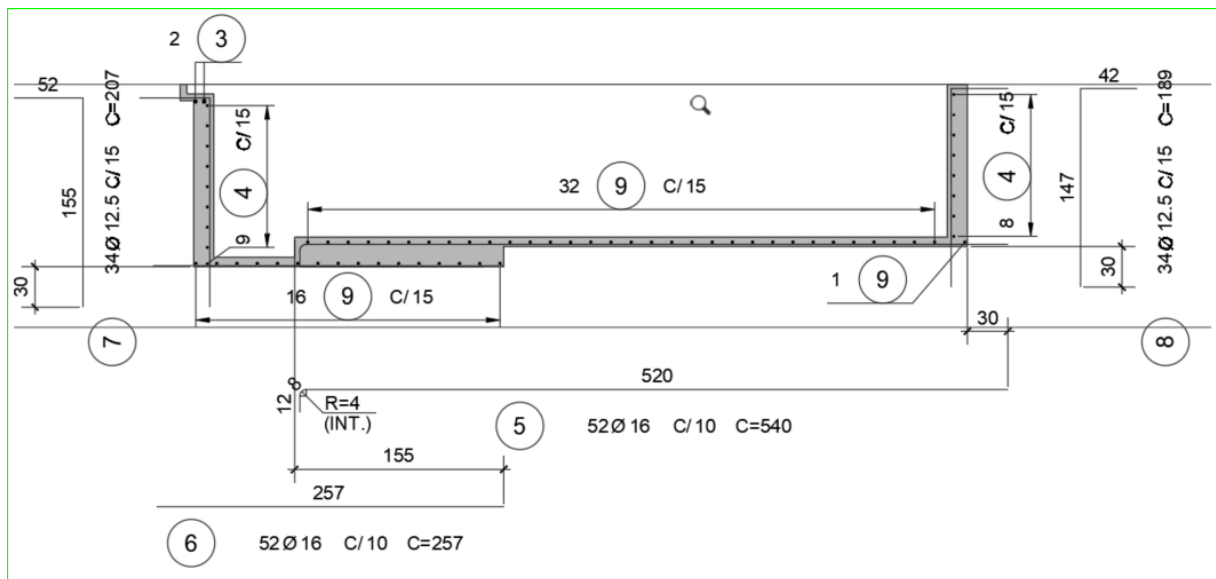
Armação dos elementos estruturais do nicho da nova escada rolante.
